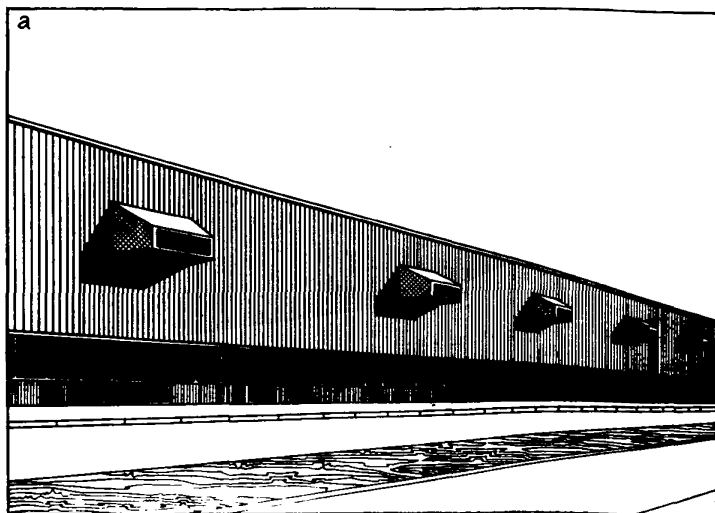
Использование вентиляционных устройств в качестве элементов, пластически обогащающих фасады производственных зданий
